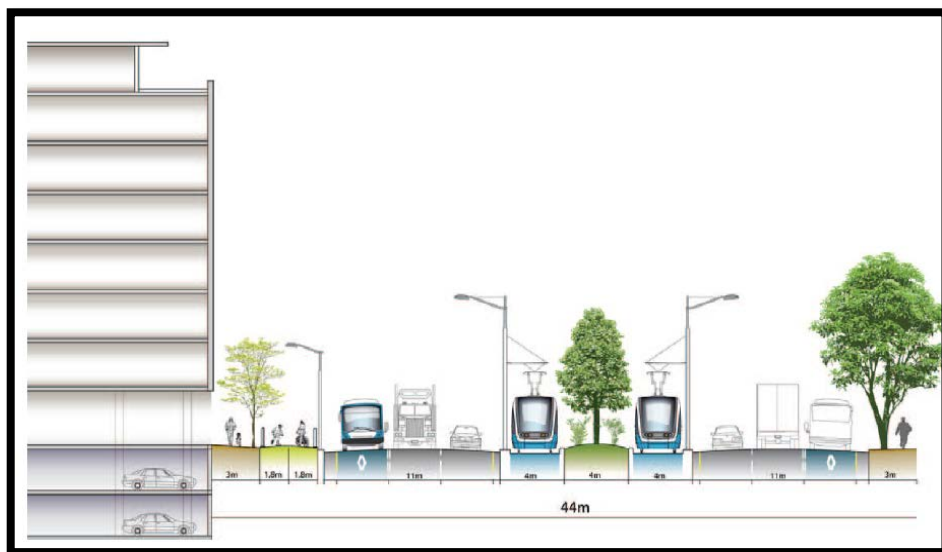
Une coupe type sur le boulevard de Notre Dame.<sup>61</sup>
